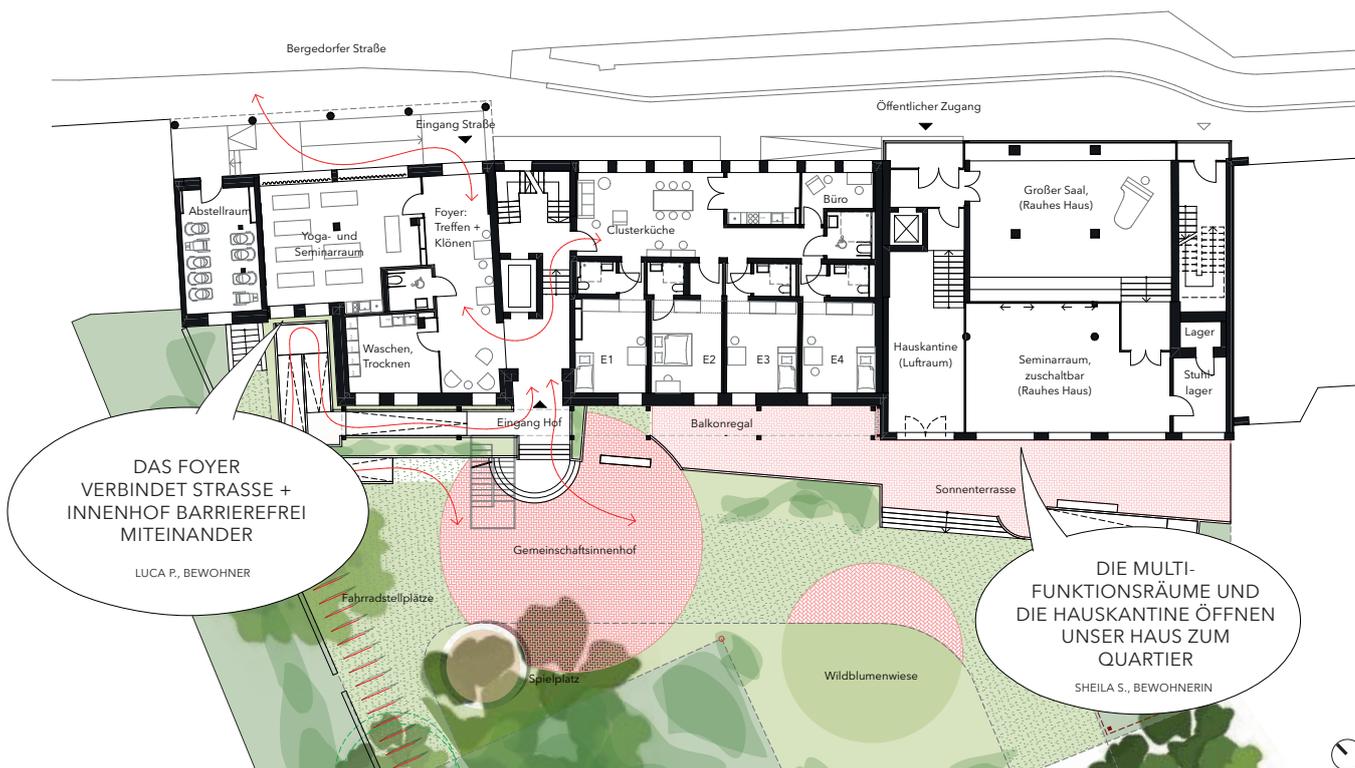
Grundriss EG und Gemeinschaftshof | M. 1:250
